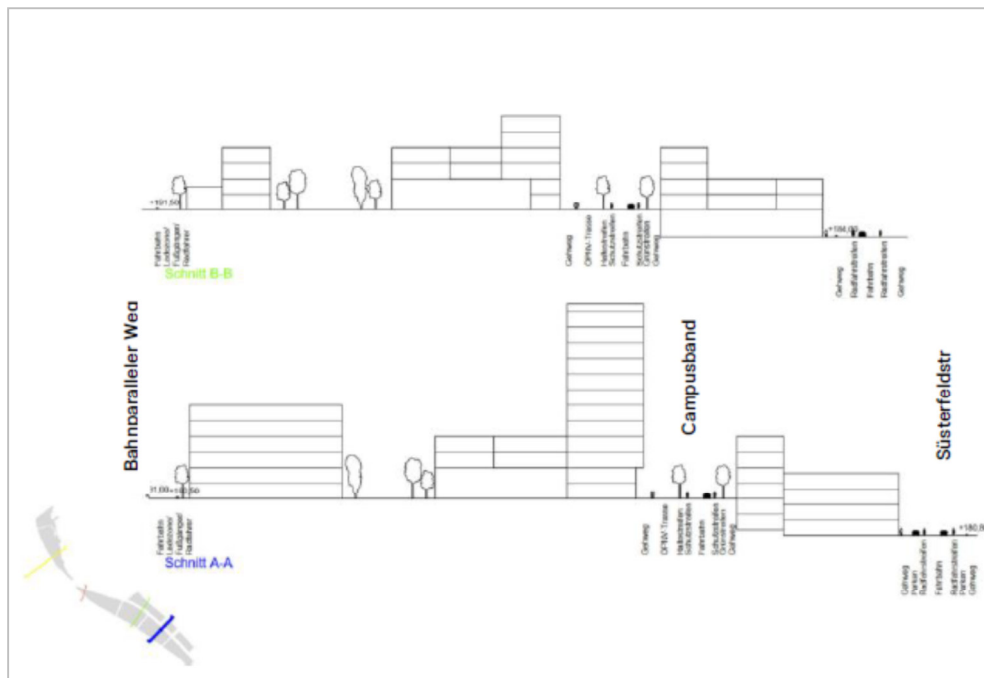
Systemschnitt - Masterplan Campus West 2019 (RKW mit FSW LA)
